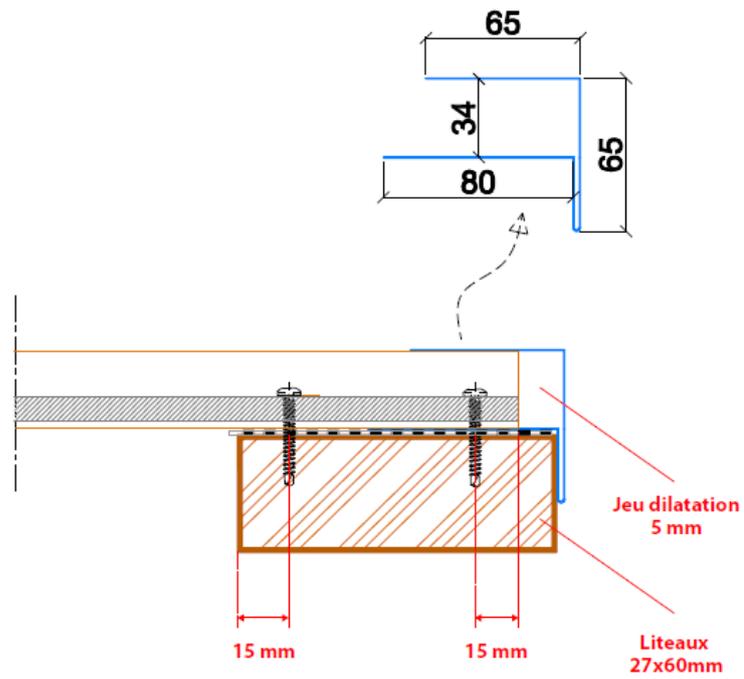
Coupe verticale : départ et arrêt haut bardage sur OB en pose verticale
